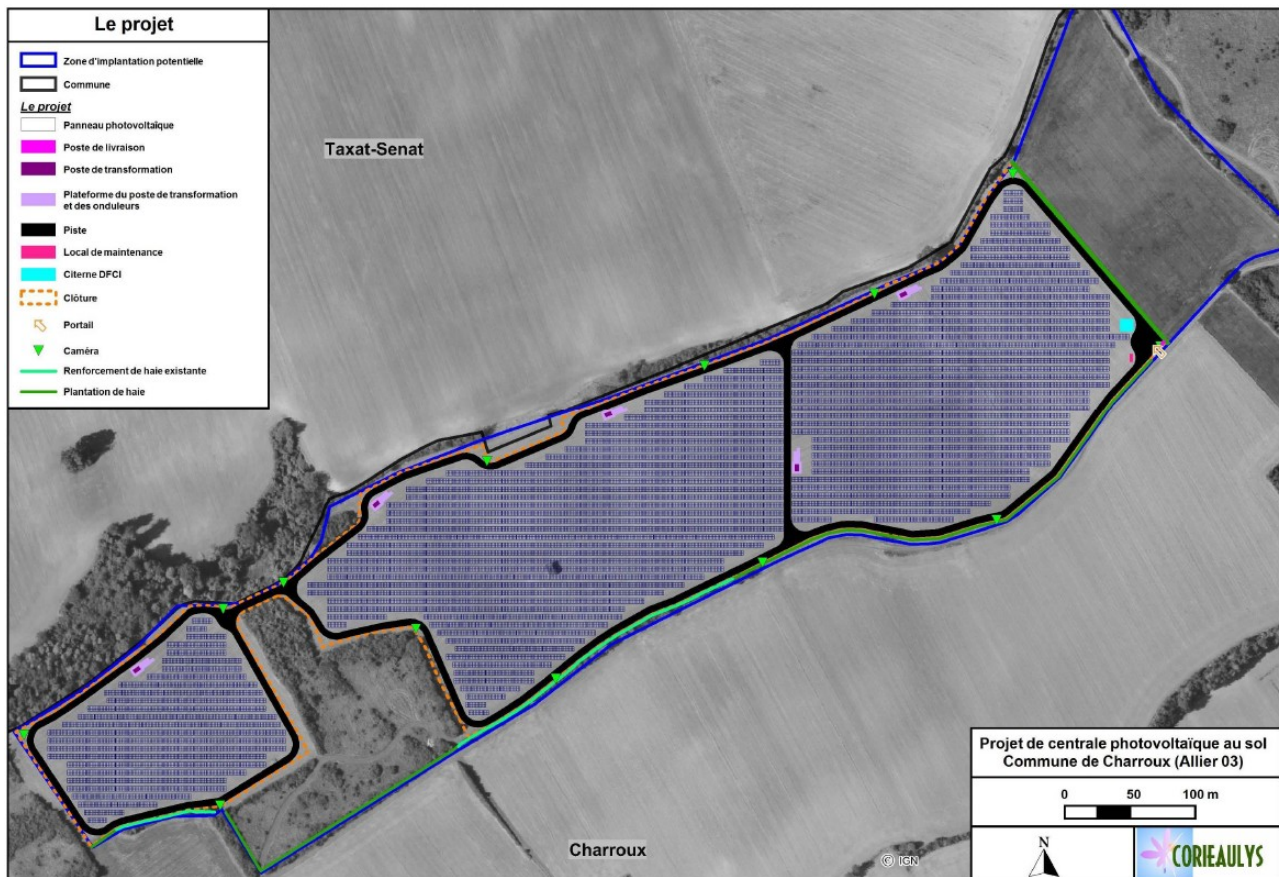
Plan d'implantation du projet (source : étude d'impact)
